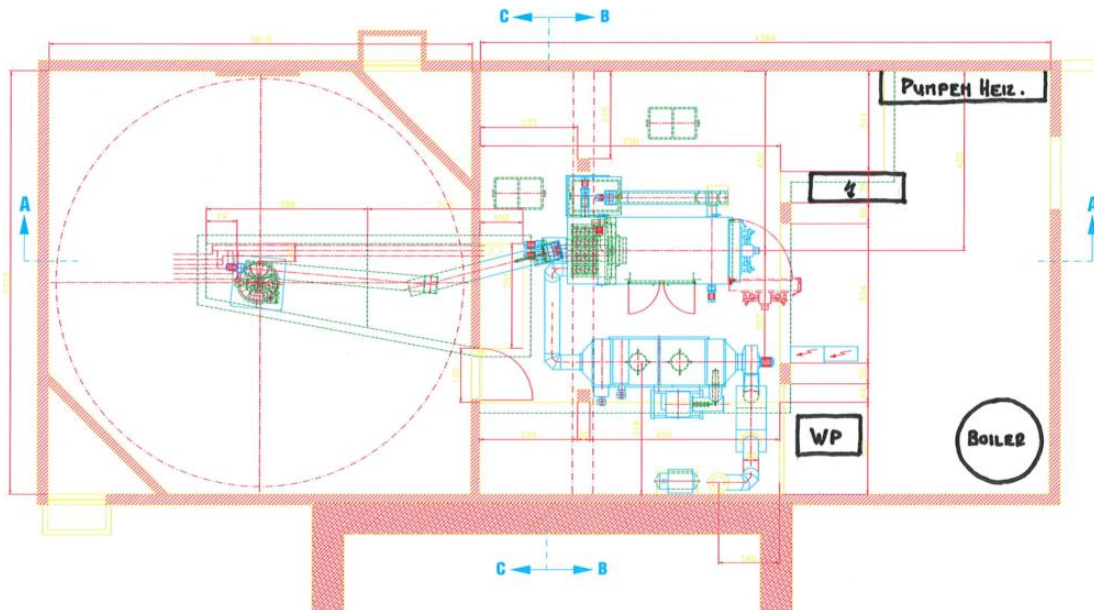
Grundriss und Fotos der bestehenden Holzfeuerung im Schulhaus Randenblick (Quelle: Strategie mit Pflichtenheft, Bollinger GmbH).
